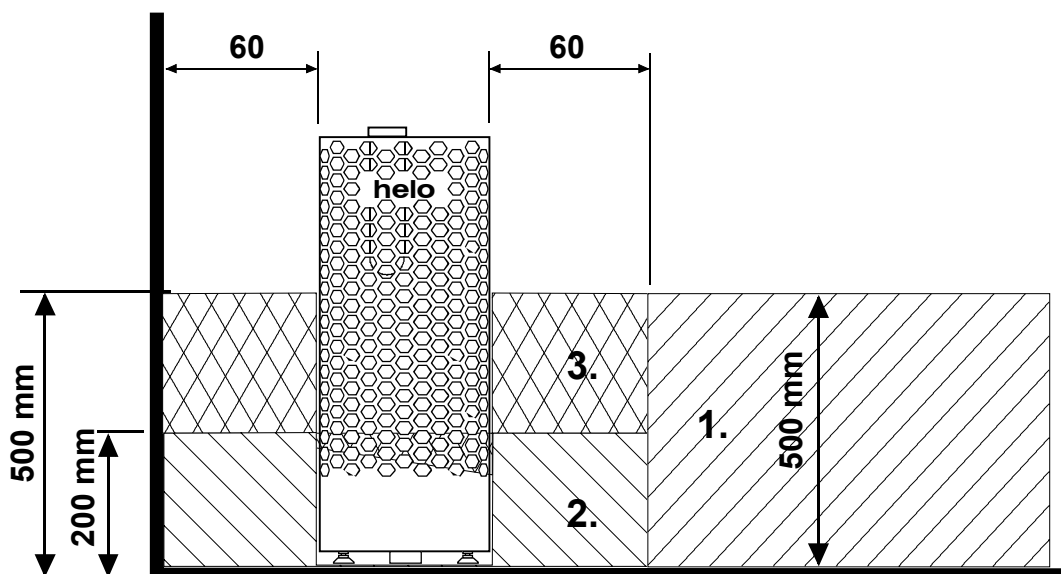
Расположение соединительной коробки для соединительного кабеля в помещении сауны
